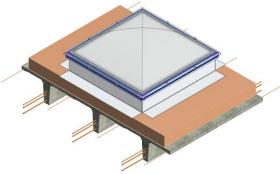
Isolation de toiture contre l'isolation du WiNa Stairvent
